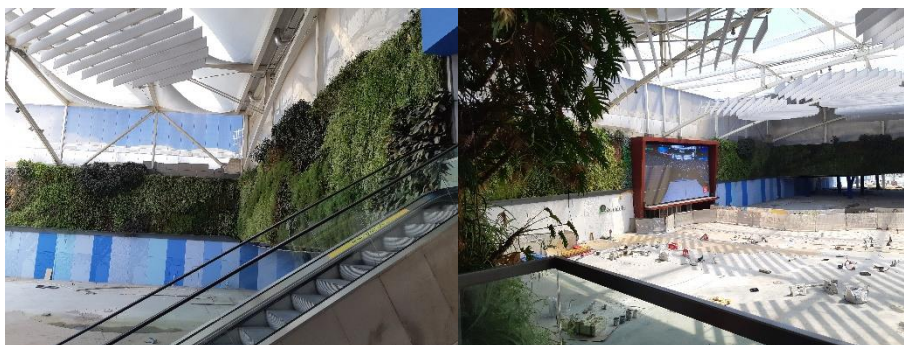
Ojedinelá instalace vertikální zahrady Patricka Blanca – Trussardi Café, Miláno
